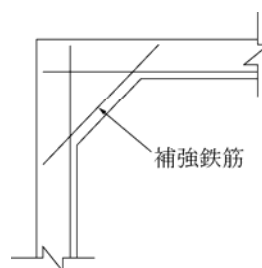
ラーメンのハンチ、内側に沿う補強鉄筋
